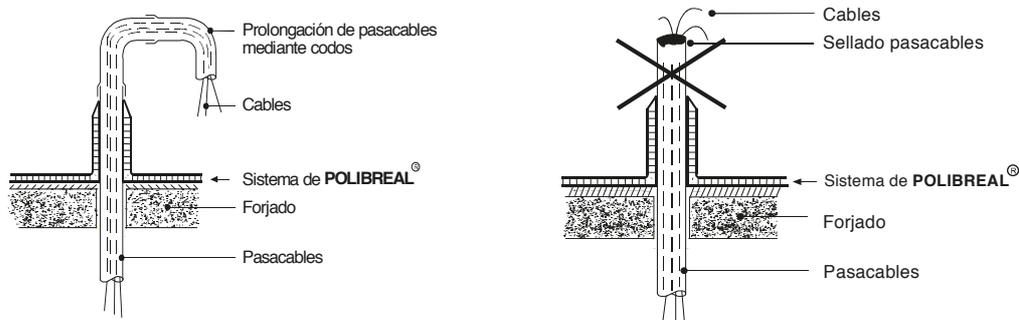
Pasa-cables curvado. Entrega del sistema POLIBREAL® con autoprotección metálica
